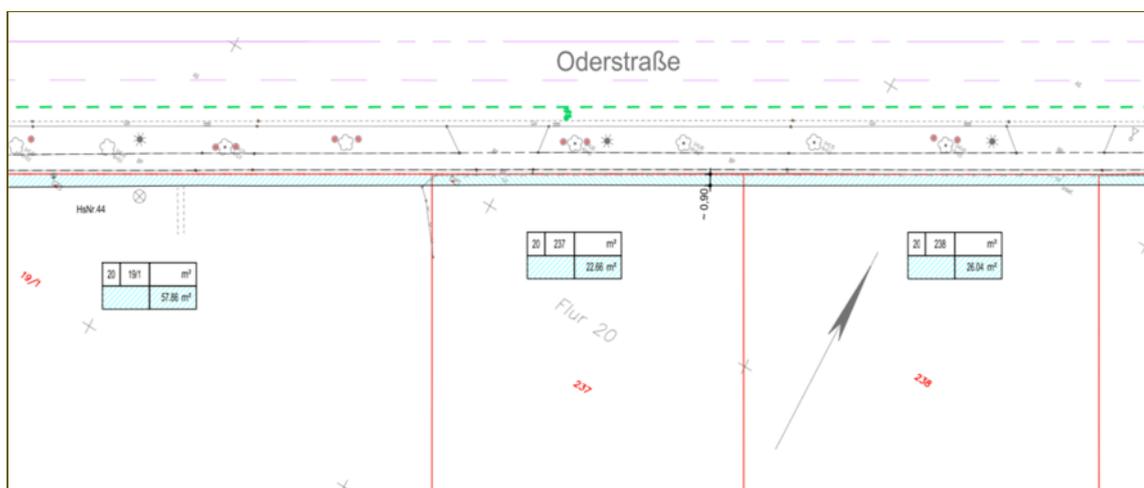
Inanspruchnahme private Grundstücksflächen Oderstraße
